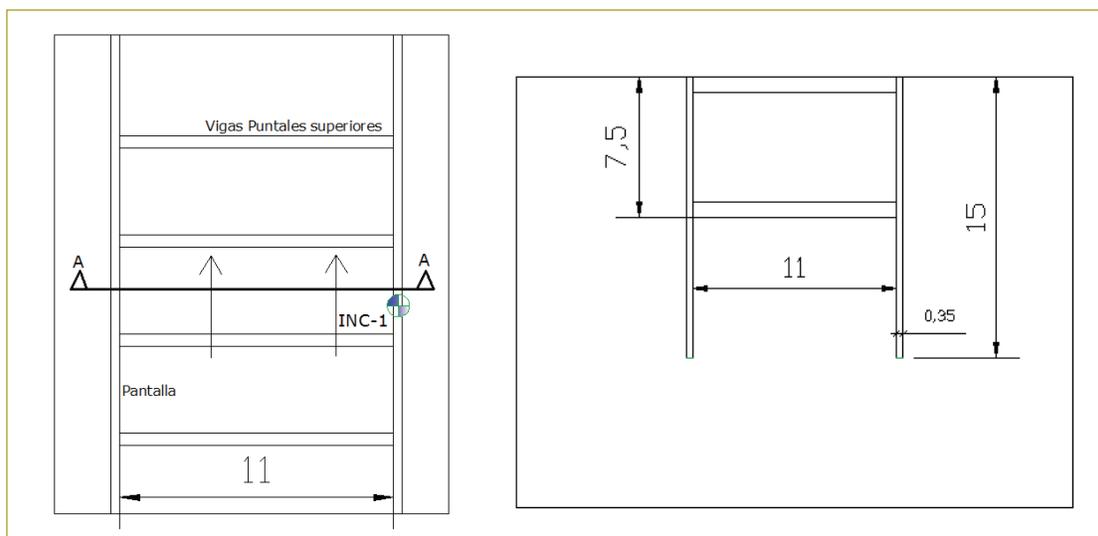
Planta y corte esquemático transversal del proyecto (sección A-A).
